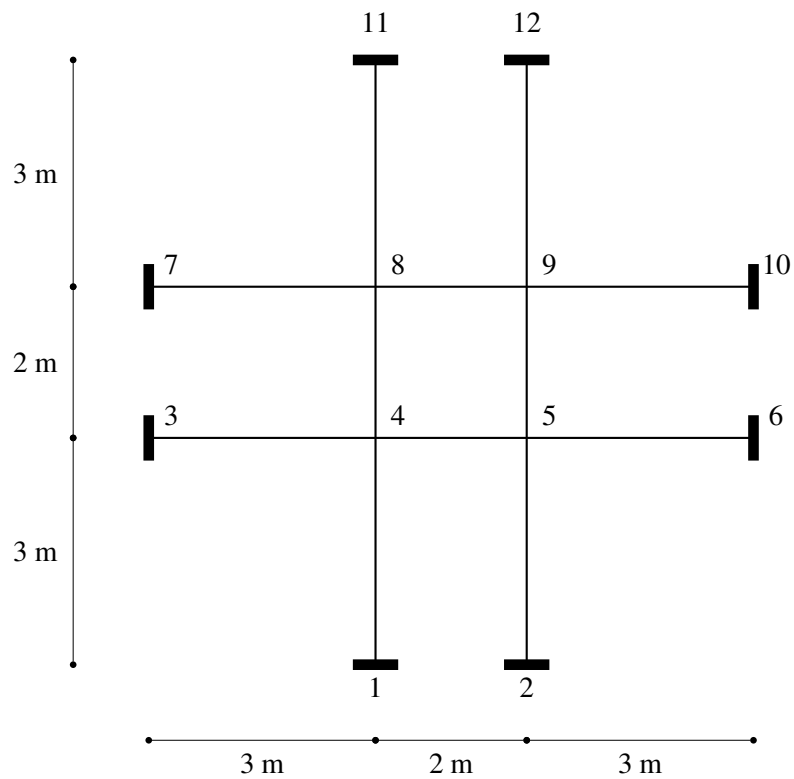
Parrilla formada por cuatro vigas empotradas (vista en planta)
